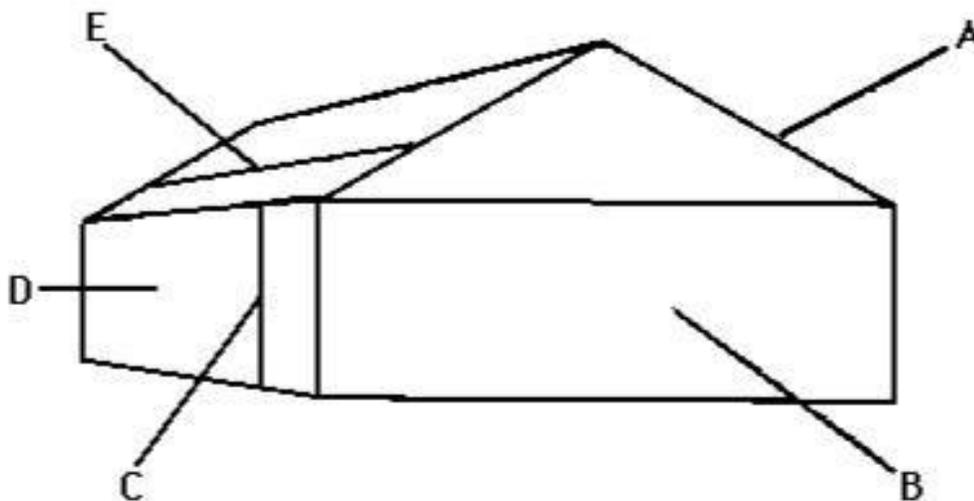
Componentes estructurales básicos de un invernadero: A) viga, B) pared final, C) poste lateral, D) pared lateral, E) correa.
